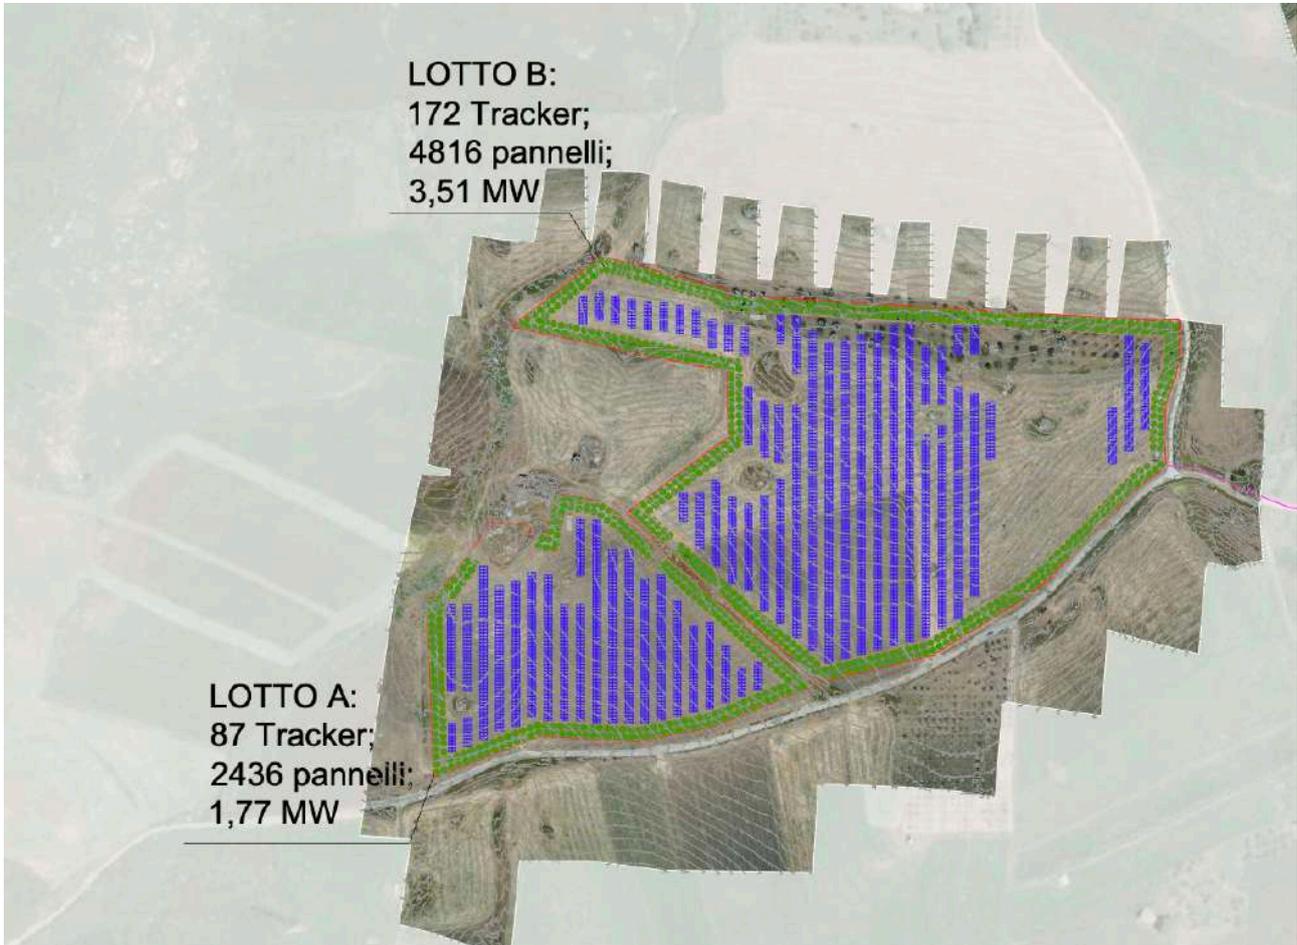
Particolare Layout di impianto area A e area B su stralcio rilievo
